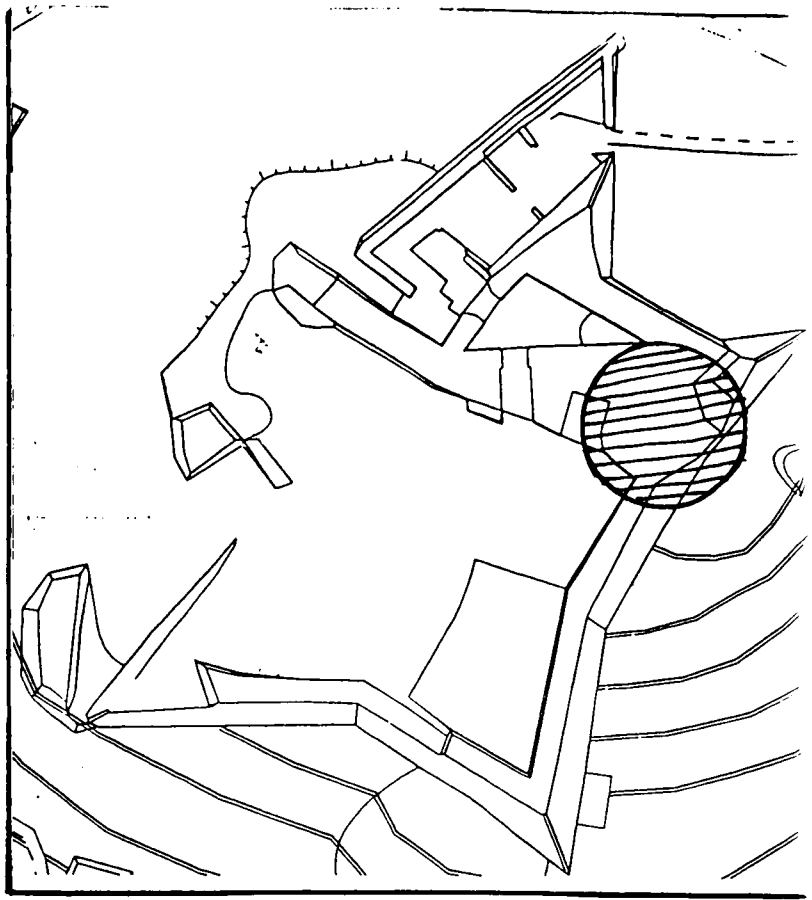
Croquis - Primera planta , punta NE (torre medieval)
